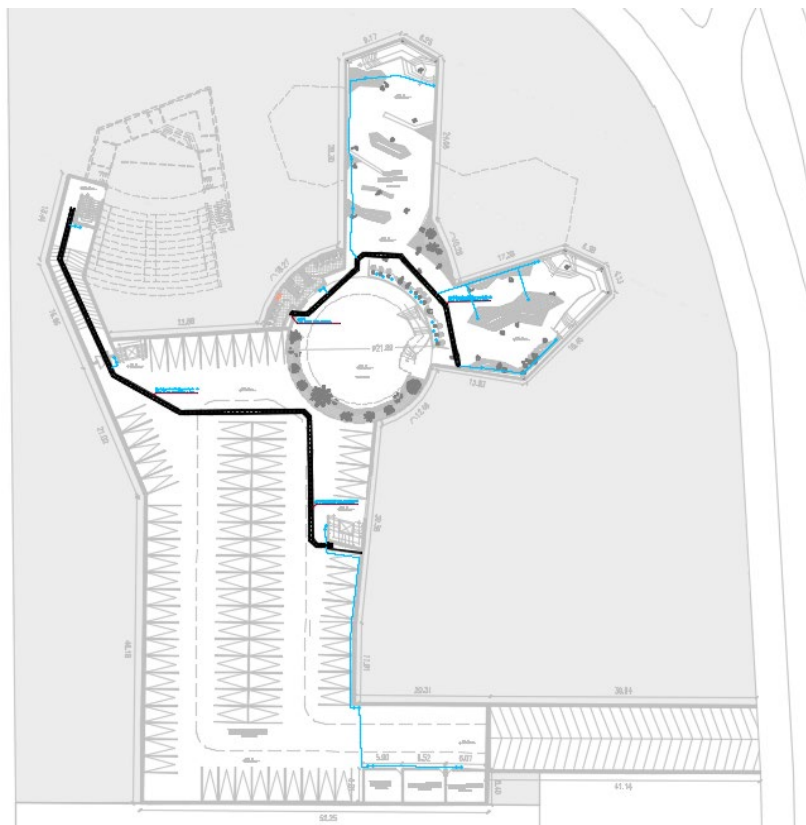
Plano distribución voz y datos en planta nivel cuatro. Elaboración propia.
